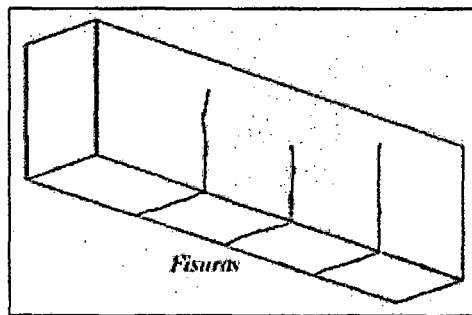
25. Fisuración transversal marcando la posición de los estribos. Fuente: (Stuardo P., 2008)
